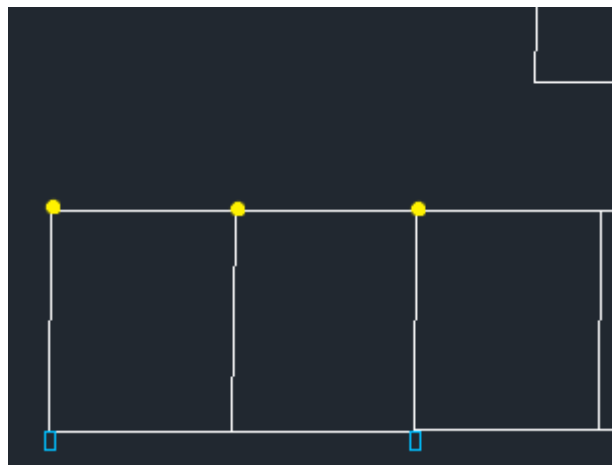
Plano iluminación plazas aisladas segunda fila.
